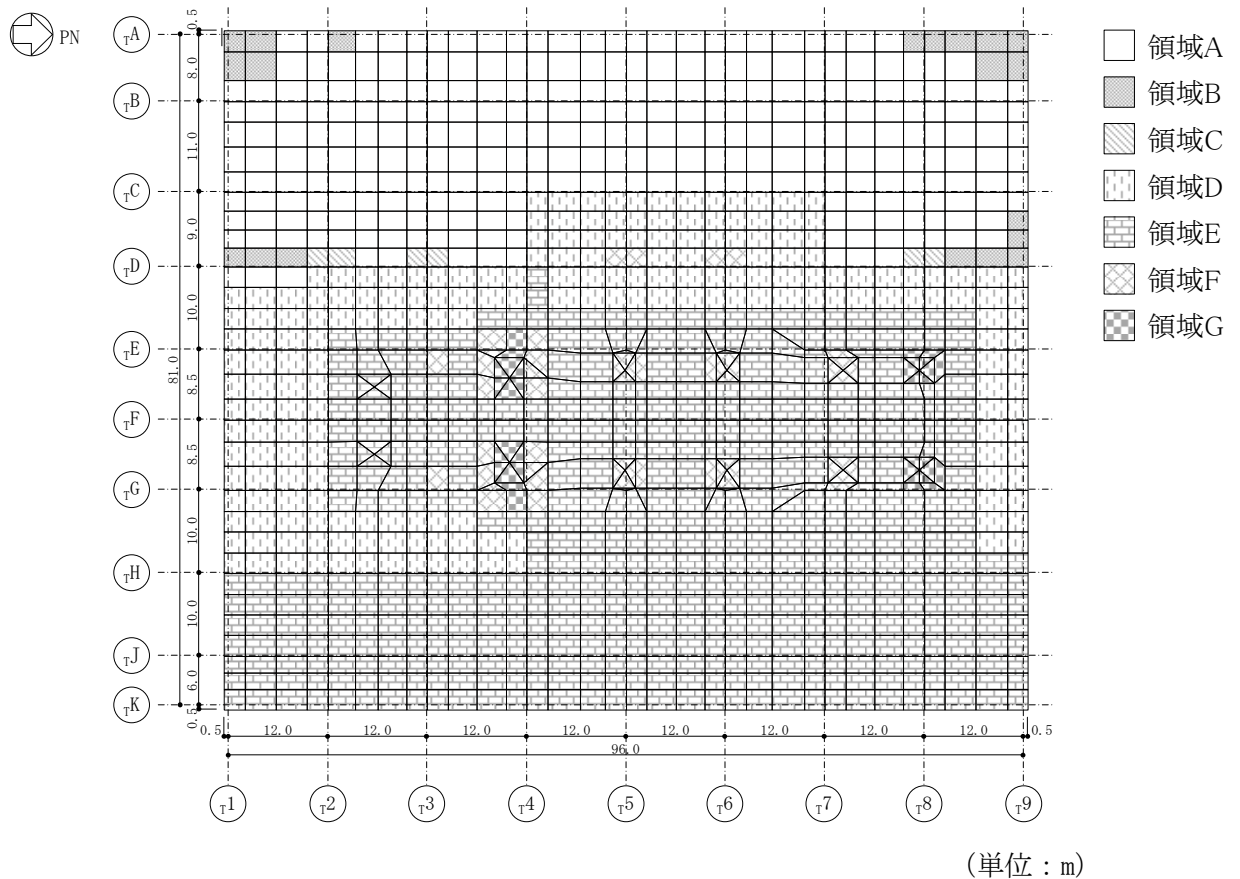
基礎スラブの配筋領域図 (EW 方向, 下ば筋)
